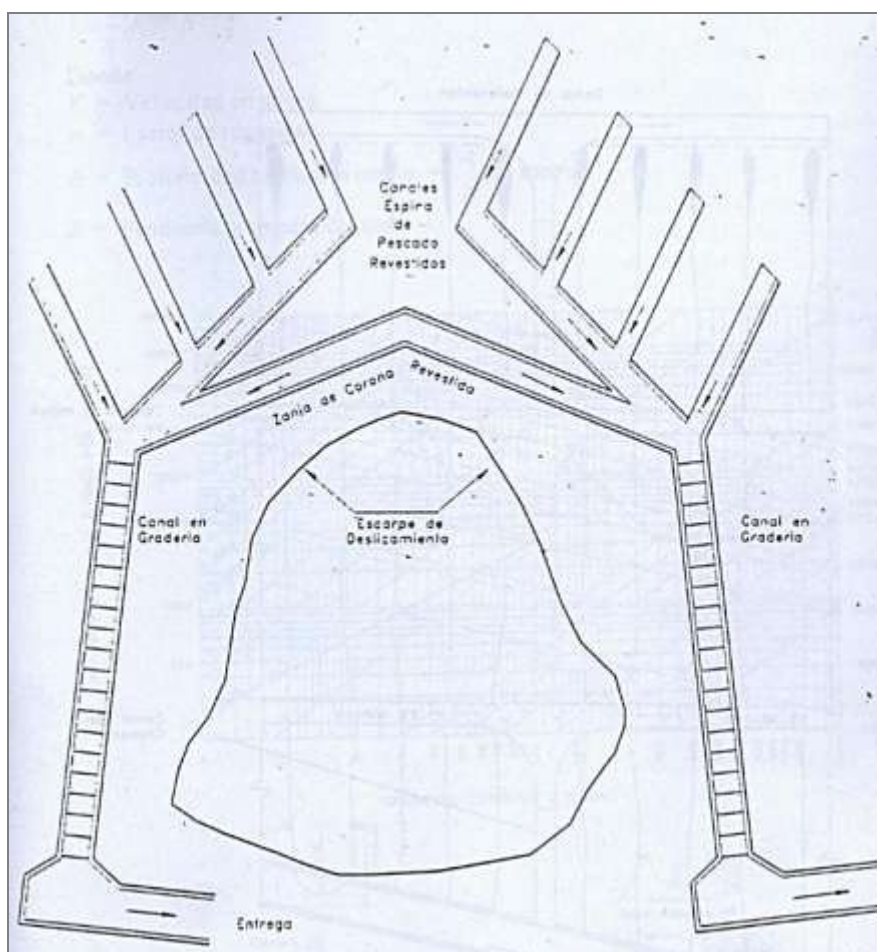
Esquema de planta de canales colectores espina de pescado con canales en gradería
